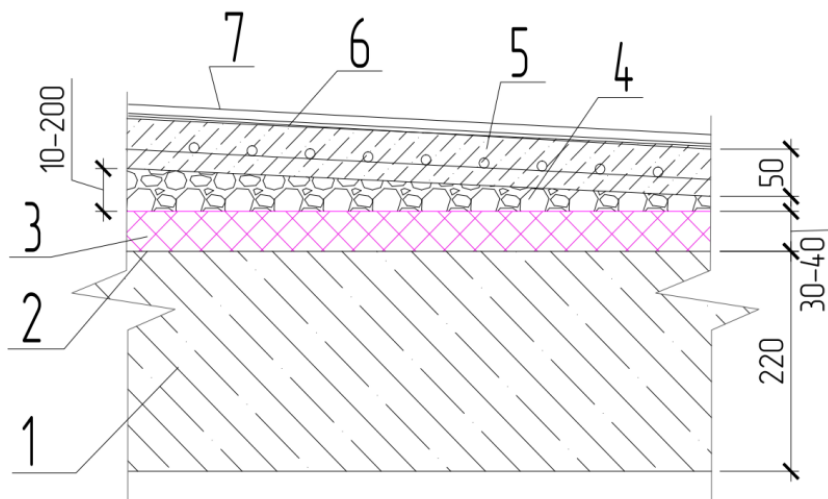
Конструкция покрытия с использованием вакуумного утеплителя: 1 – железобетонная плита покрытия 220мм, 2 – унифлекс ТПП, 1 слой, 3 – вакуумная панель 30 мм, 4 – керамзитобетонный гравий 10 – 200 мм, 5 – армированная ц/п стяжка – 50 мм, 6 – праймер битумный, 7 – техноэласт.
